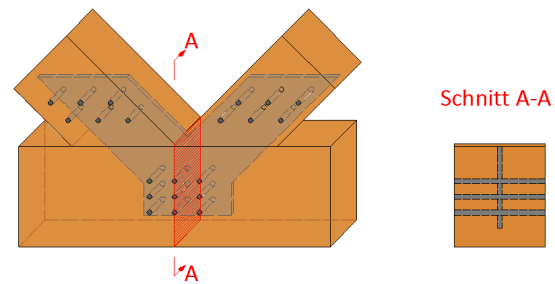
Fachwerkträgerknoten mittels Stahlblech-Holzverbindung
